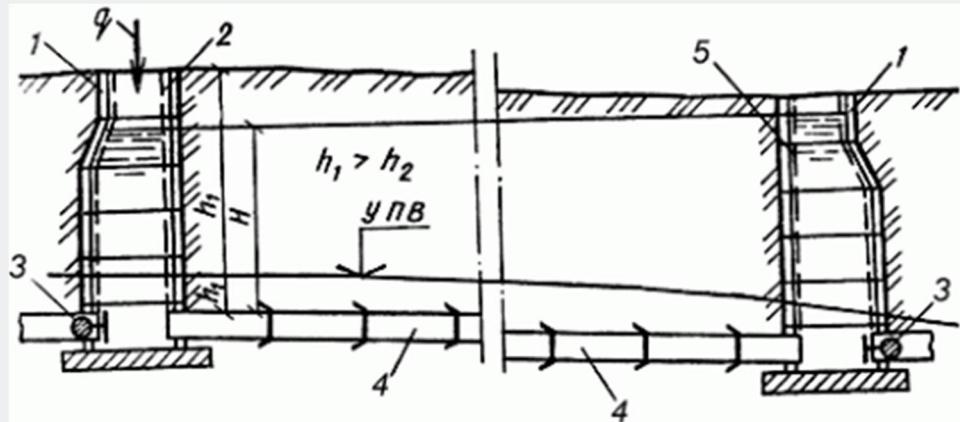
Схемы приемочного испытания безнапорного трубопровода с колодцем с внутренней гидроизоляцией
